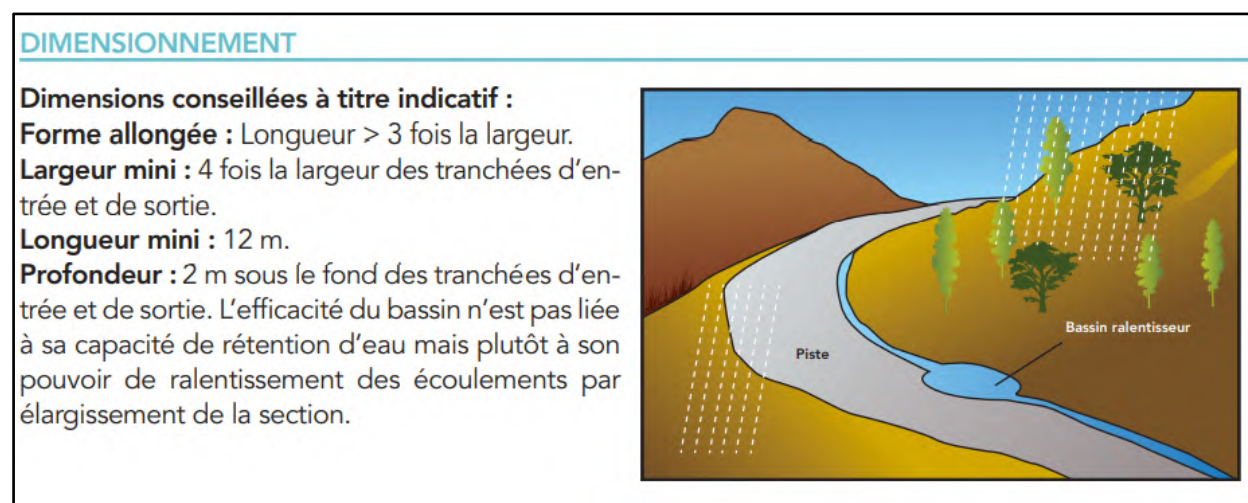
Principe de dimensionnement des bassins ralentisseurs (Extrait du guide pratique des techniques et ouvrages hydrauliques, SLN)
